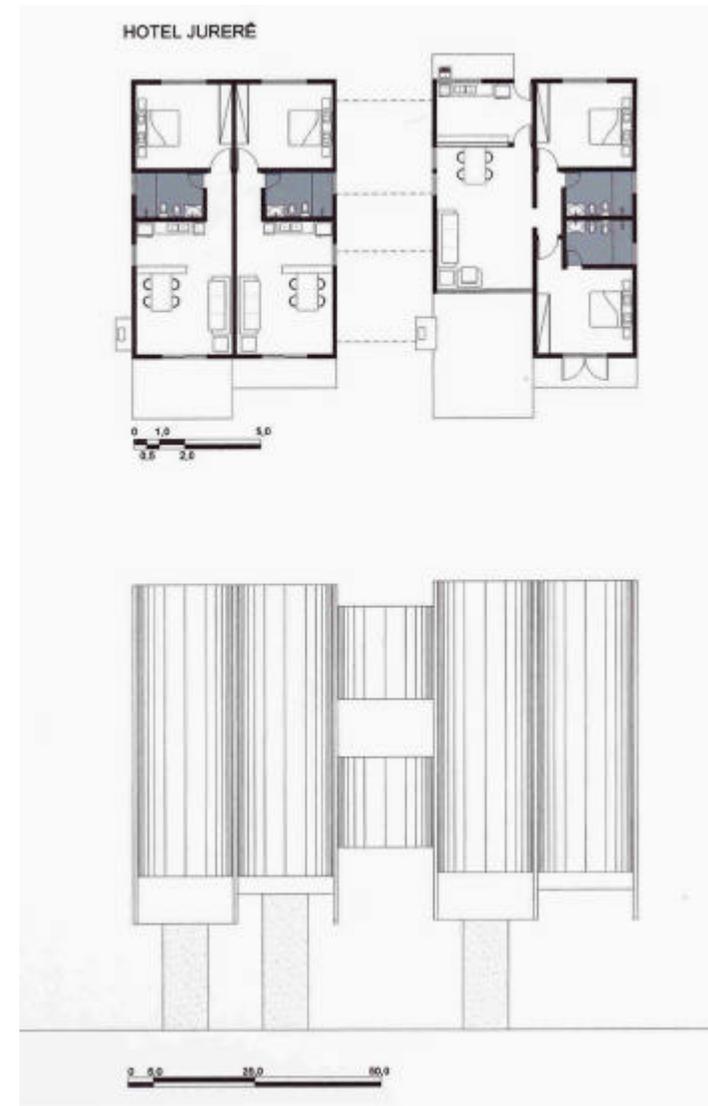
Jurerê Praia hotel. Plantas Bajas tipo amuebladas y cubierta. (F.: Paulo Edi)
